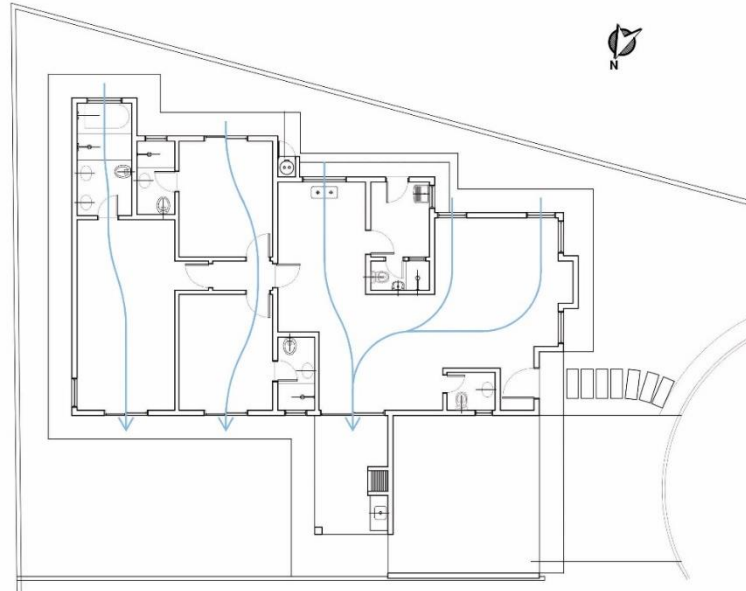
Ventilação do Pavimento Térreo – Residência 03.
